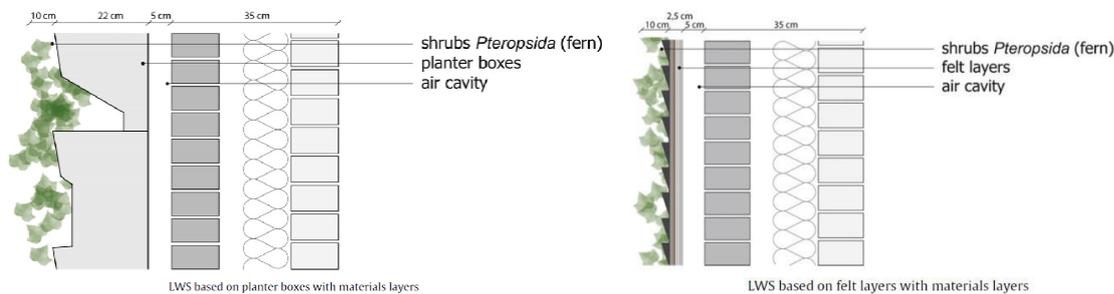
Façade vivante (Source : khadraoui 2019)
